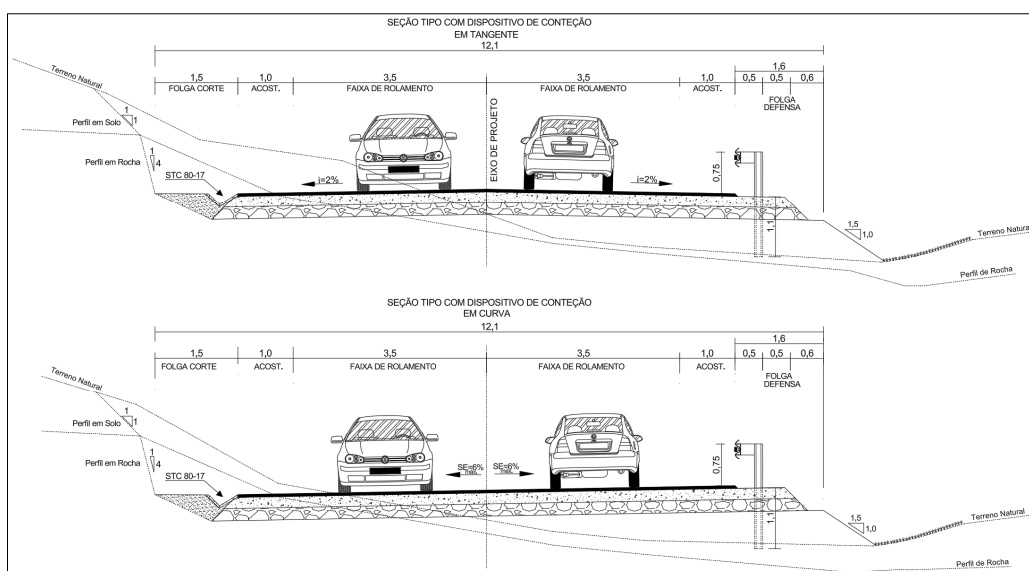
Elementos da Seção Transversal-Tipo de Terraplenagem.
